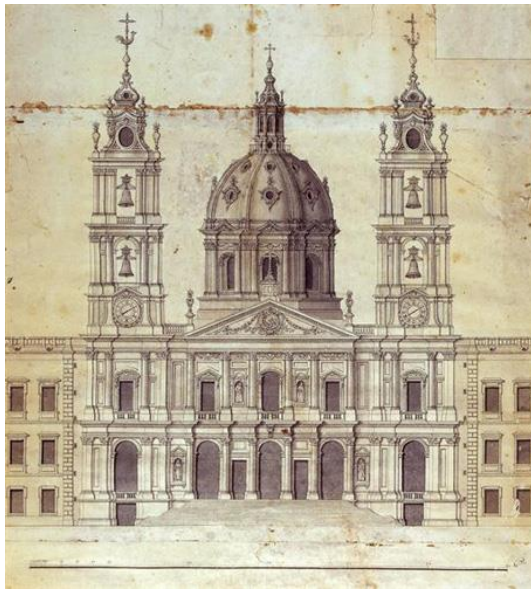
Fachada da Basílica de Mafra, desenho de Machado de Castro.
